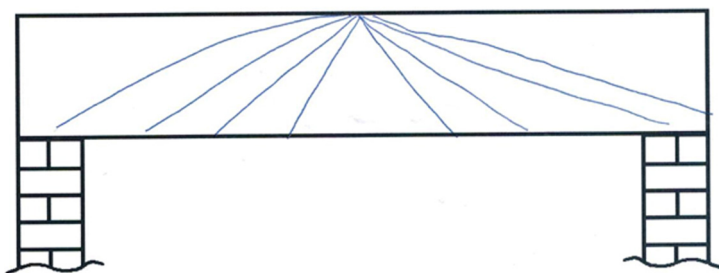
Schülerzeichnung 1 zur Lage der Bewehrung in einem Stahlbetonbalken (eigene Darstellung).
